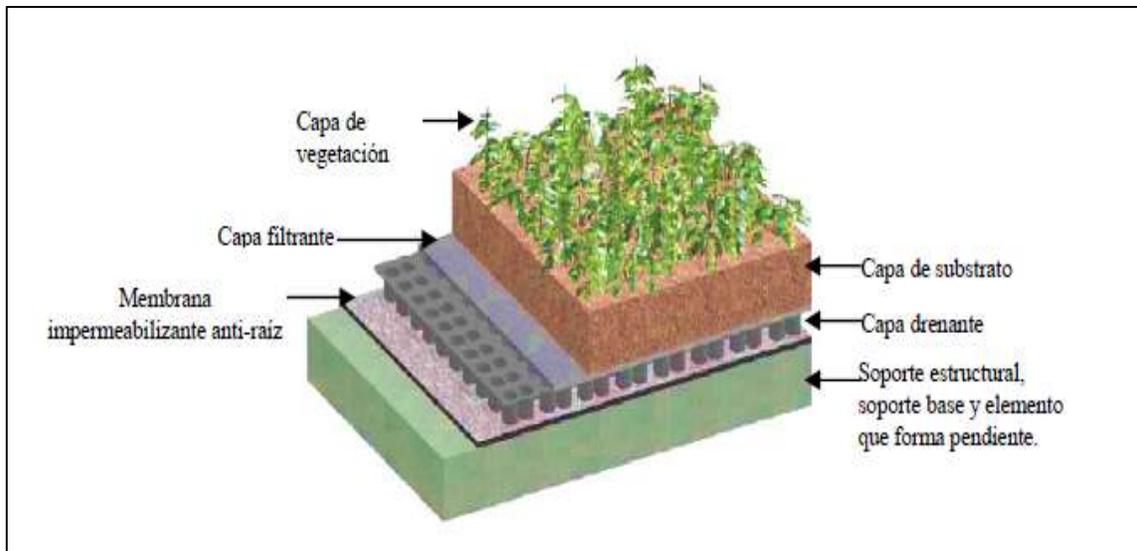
Componentes de una cubierta naturalada o techo verde
